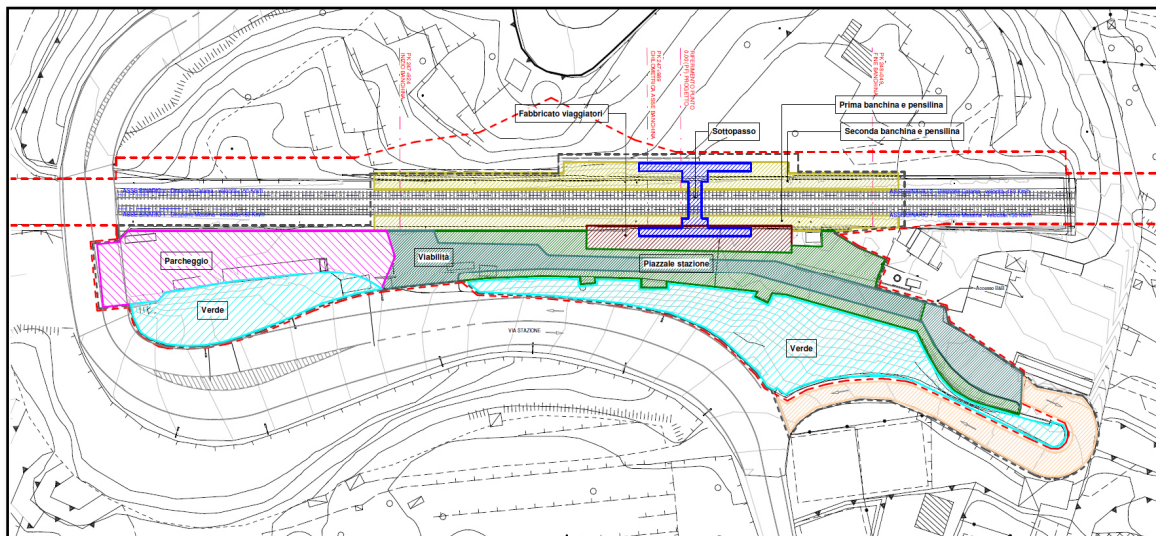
Perimetrazione area di intervento su planimetria catastale
